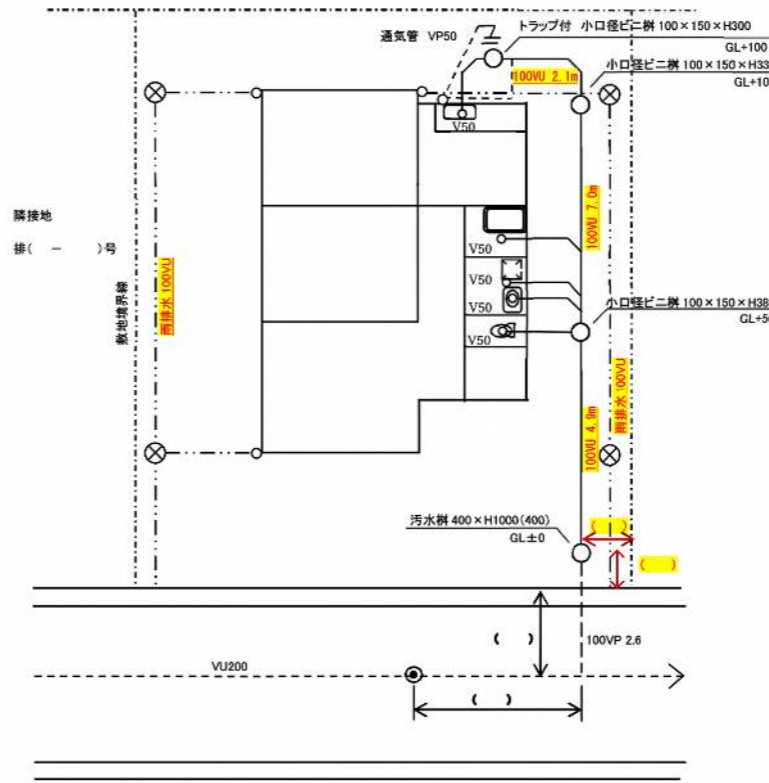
排水設備標準図 (例 2) 平面図縮尺 1/200
